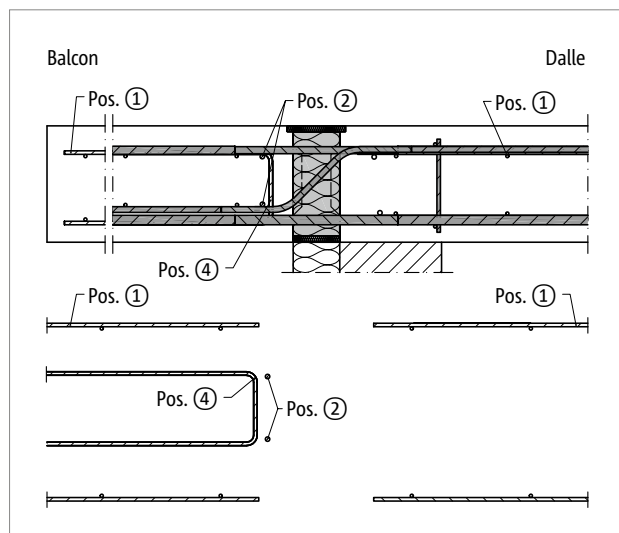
Schöck Isokorb® T types K-M13 à M14 : renforcement sur site pour support direct
